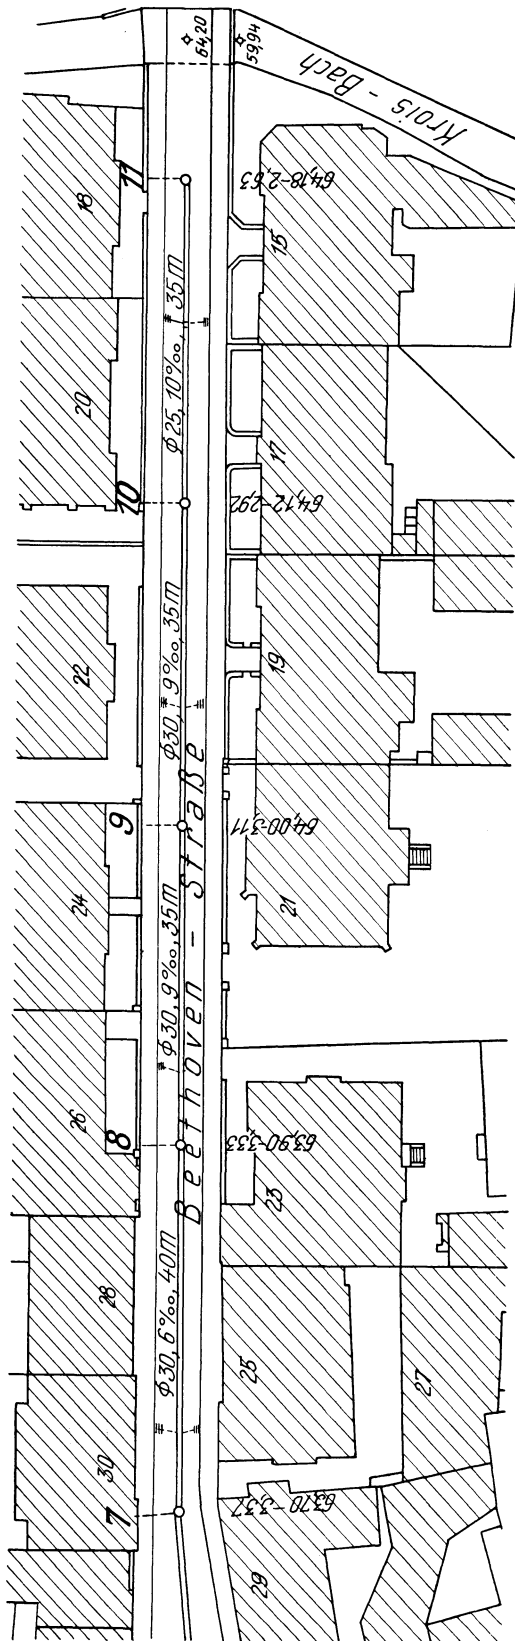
Lageplan großen Maßstabes mit dem eingezeichneten Kanalstranz, den Einsteigschächten und den Straßeneinläufen. (Stadtbaumeister Graz)
